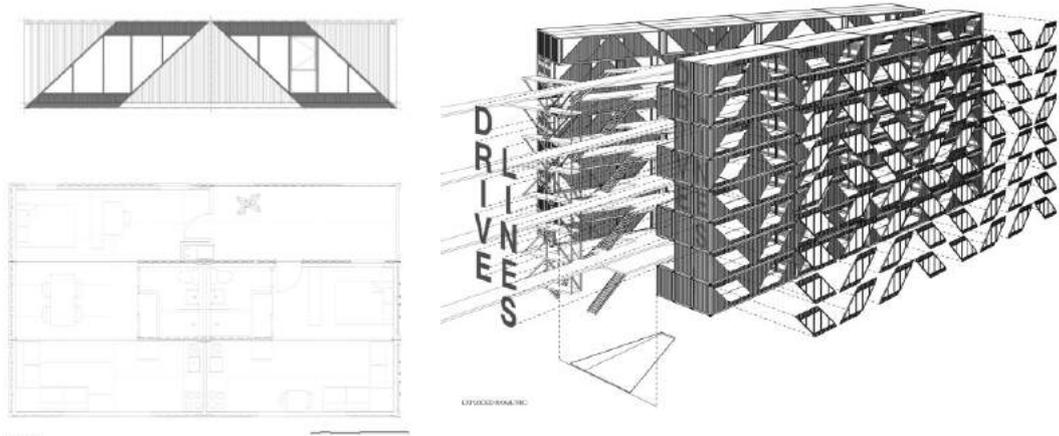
Desenho técnico da Planta e Alçado topologia *D3 Abwab Pavilion* (Archdaily, 2017)
